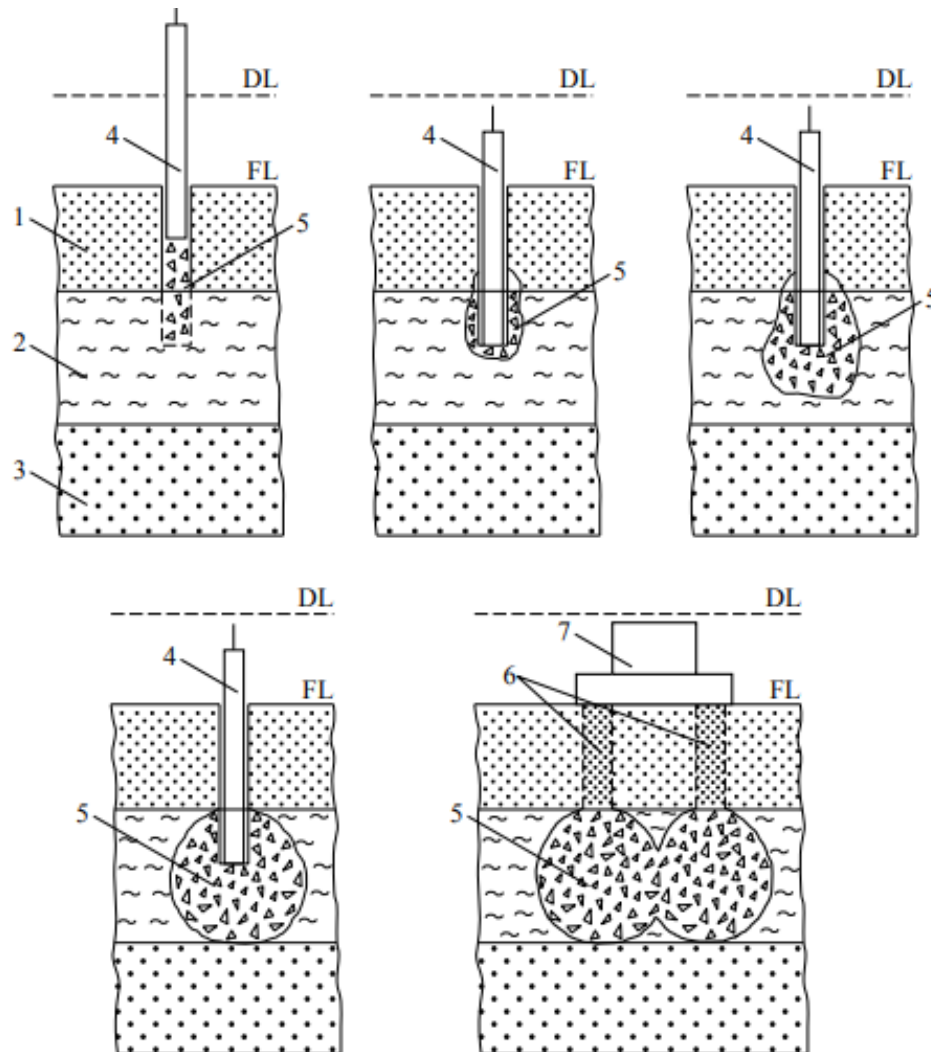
Послідовність улаштування фундаменту на слабкому підстильному шарі, який укріплено втрамбовуванням щебеню (пробивання свердловини, стадії втрамбовування щебеню, влаштування фундаменту мілкого закладання): 1 – намитий ґрунт; 2 – слабкий шар; 3 – підстильний шар; 4 – циліндрична трамбівка; 5 – порції щебеню; 6 – свердловини; 7 – фундамент
